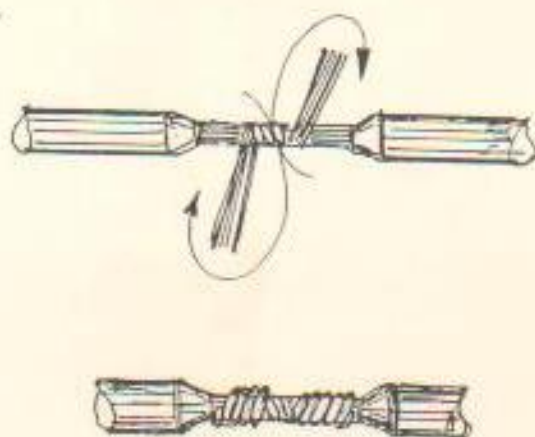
PROLONGACION DE CABLES SOBRE CABLES. (De secciones pequeñas).
